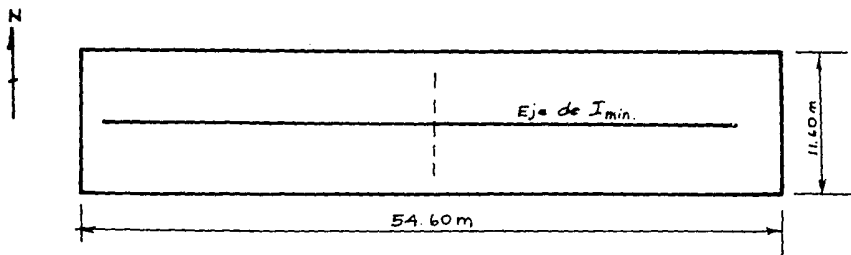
c Planta del edificio Escuela 159. Esc. 1:400.
